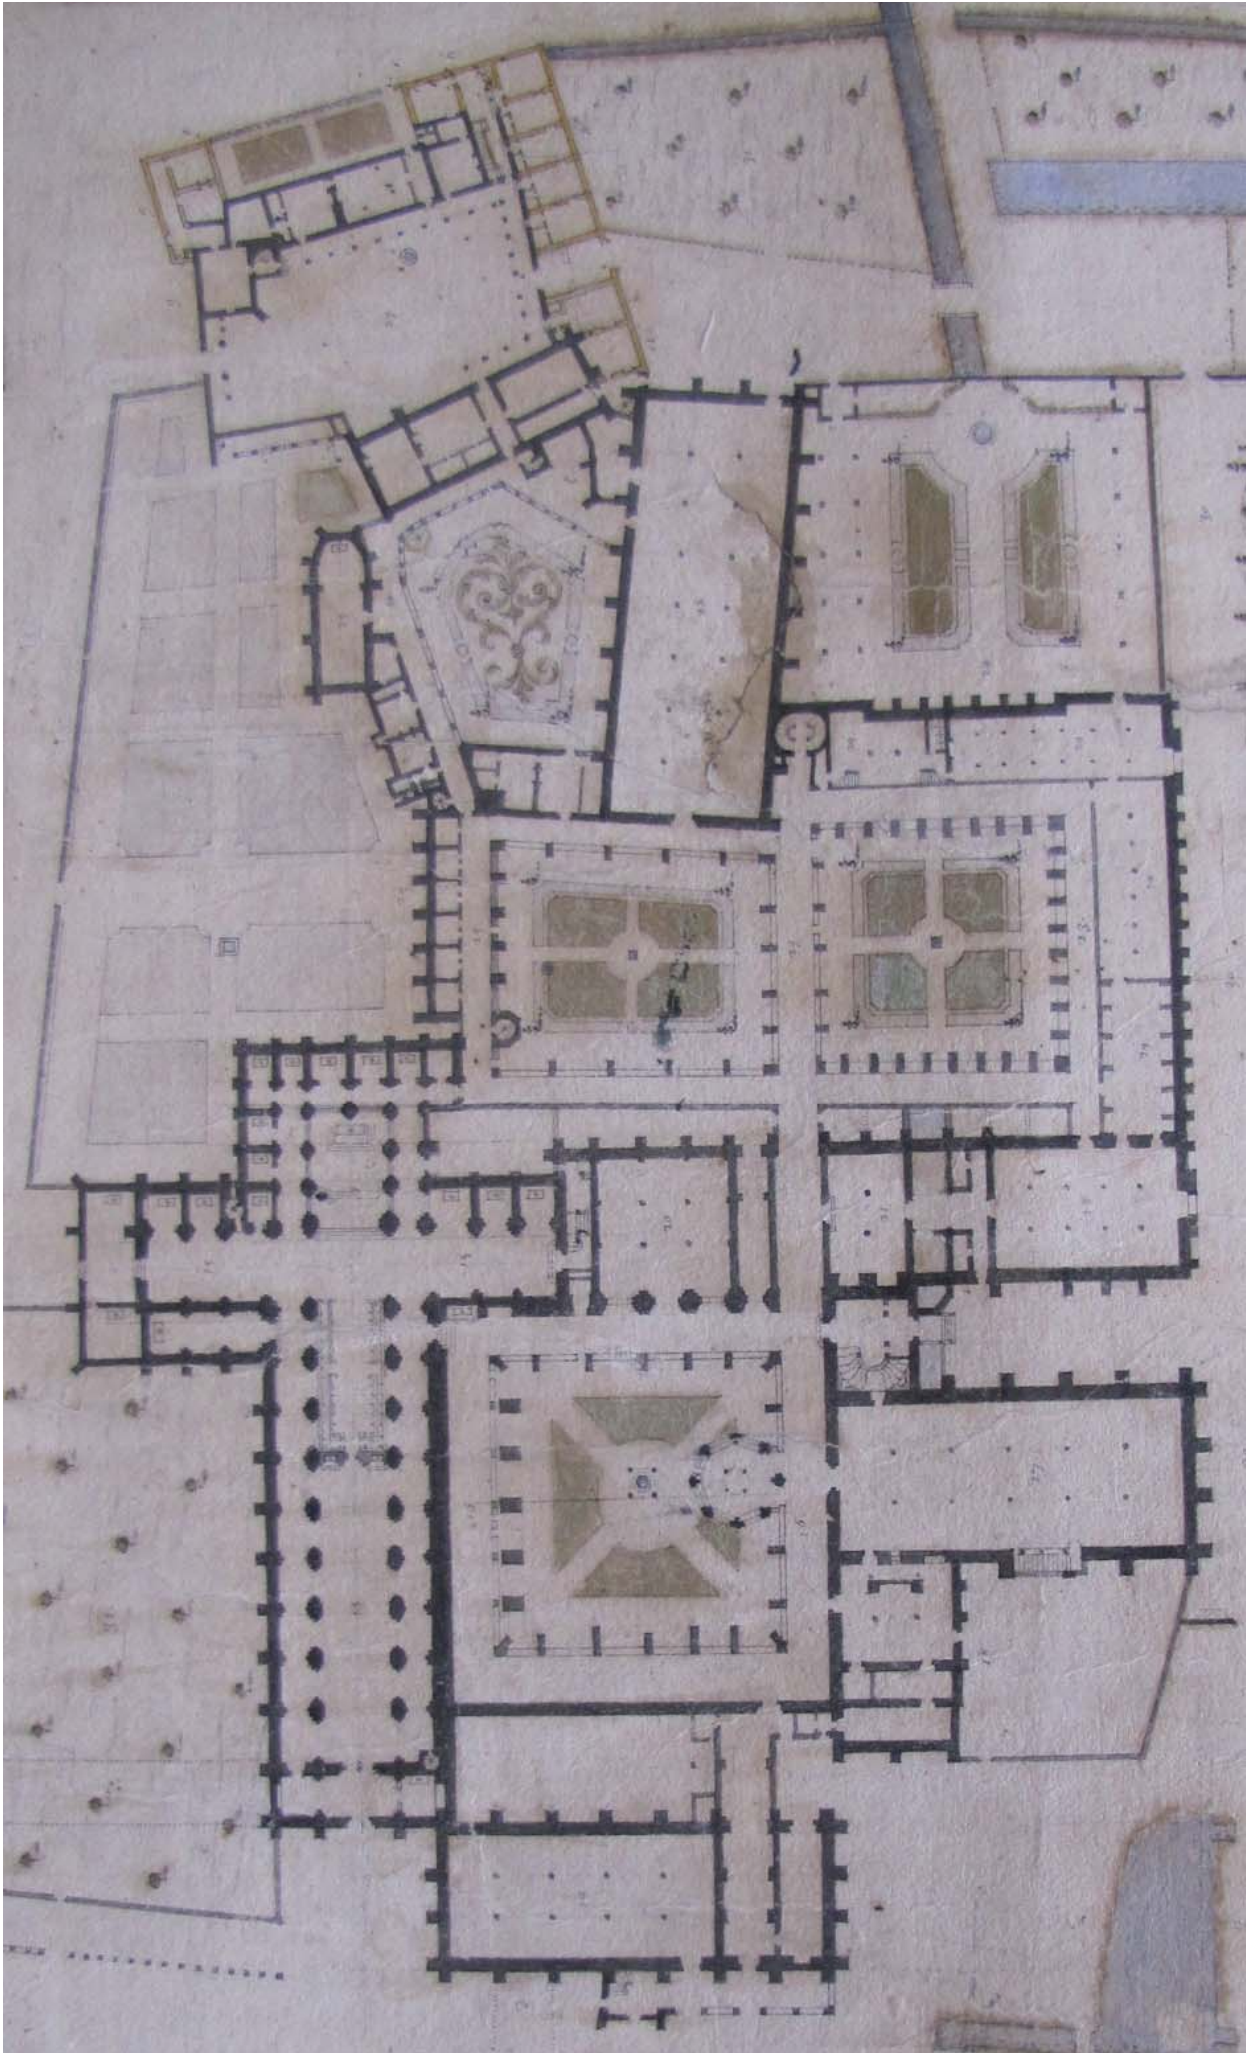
AD21, 11 H 209. Plan de Cîteaux en 1717
